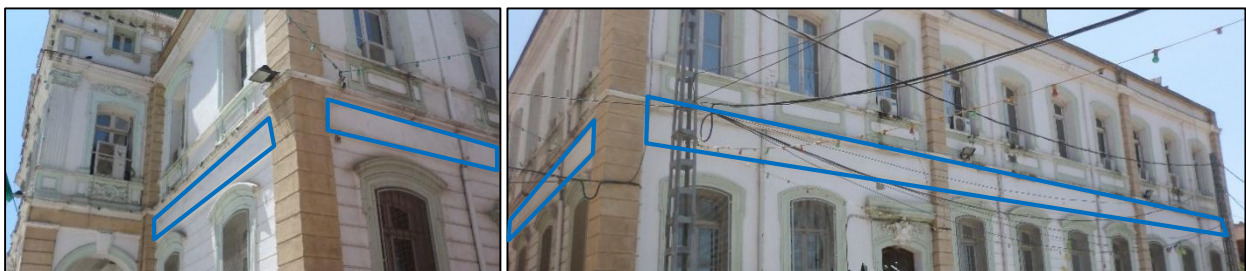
Rajout de bandes sortantes toute autour de la bâtisse (après l'intervention)
